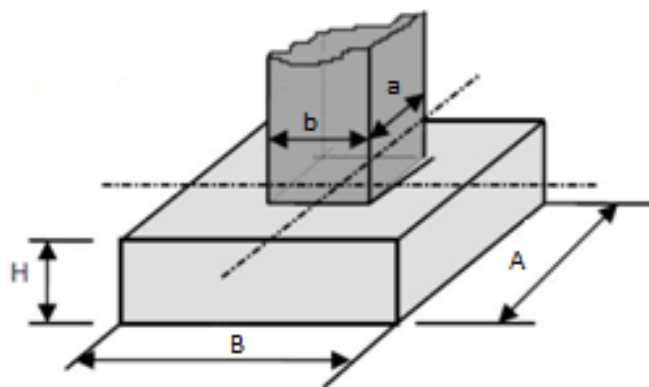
Semelle isolée (KASSOUL, 2016).
